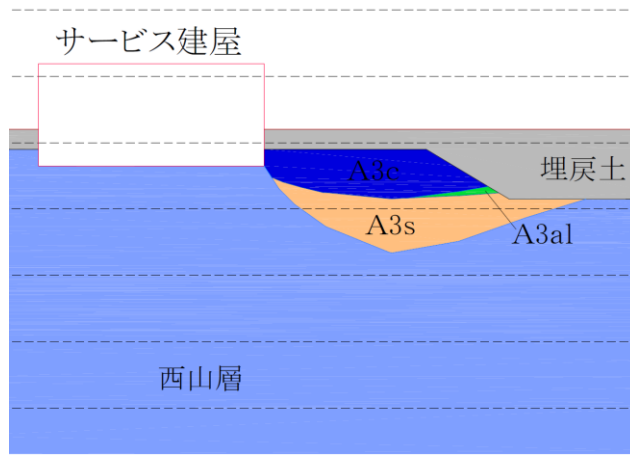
サービス建屋の設置状況（断面図，A-A断面）
